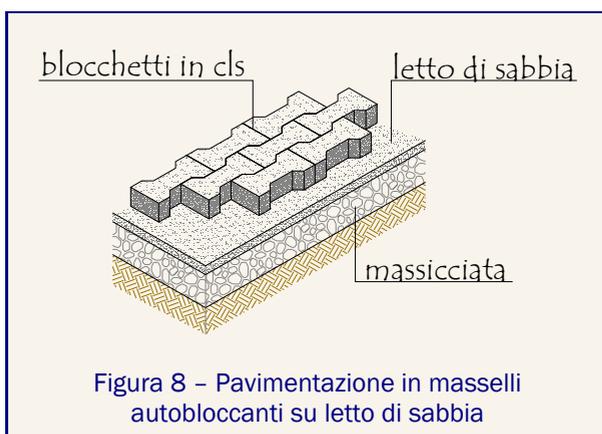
Pavimentazione in masselli autobloccanti su letto di sabbia
